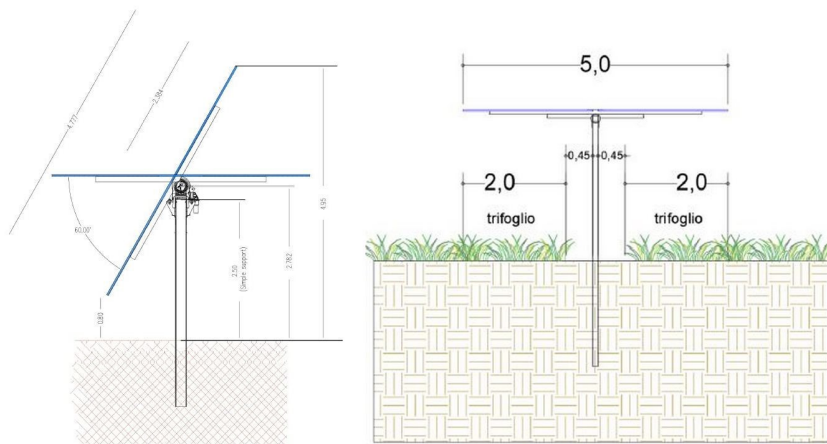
Sezione dell'area dell'impianto con indicazione delle scelte progettuali
